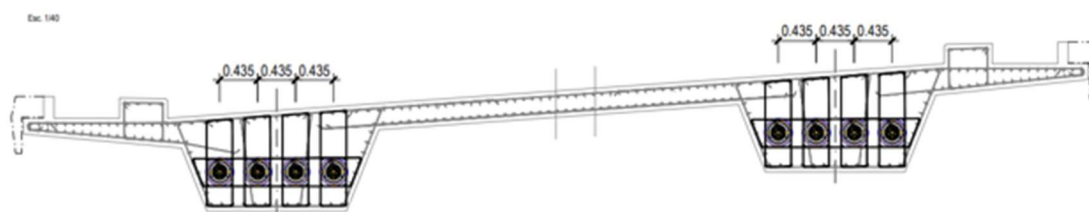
Corte transversal dos tabuleiros com a solução de pré-esforço adotada
